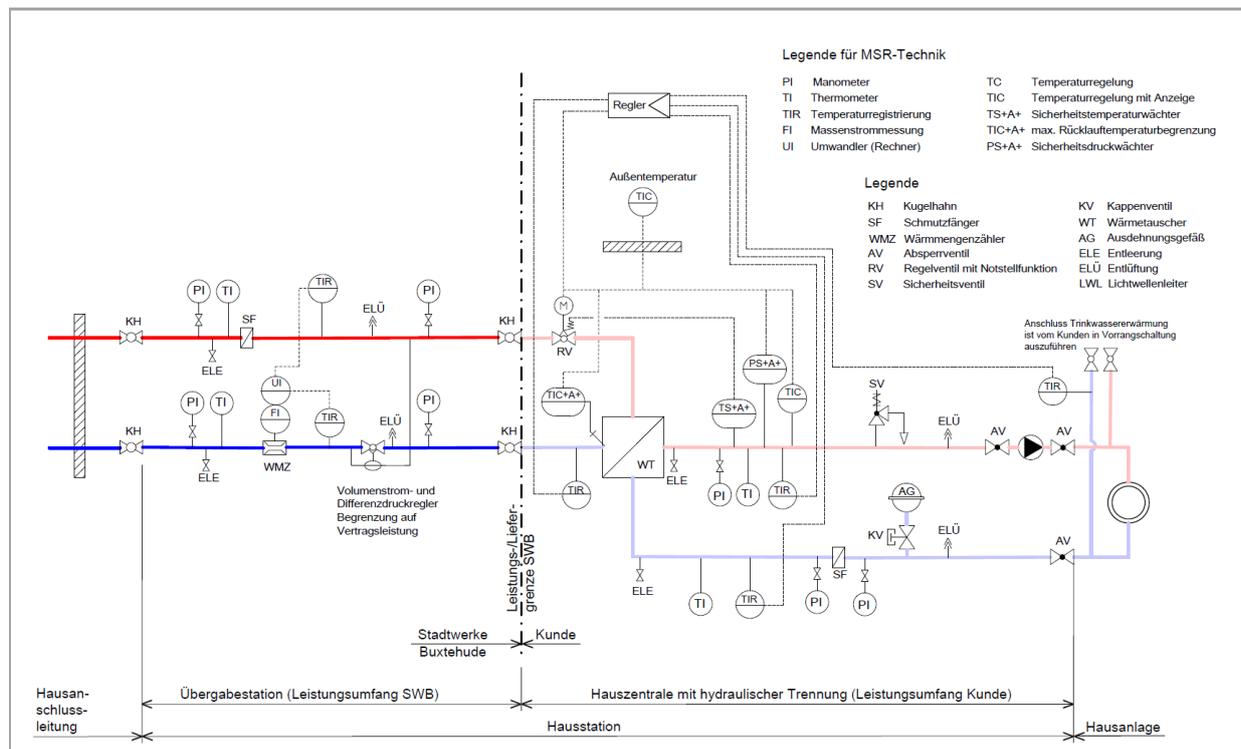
Schema mit Kennzeichnung der Anlagenteile „Übergabestation – Hauszentrale – Hausstation – Hausanlage – Hausanschlussleitung“
